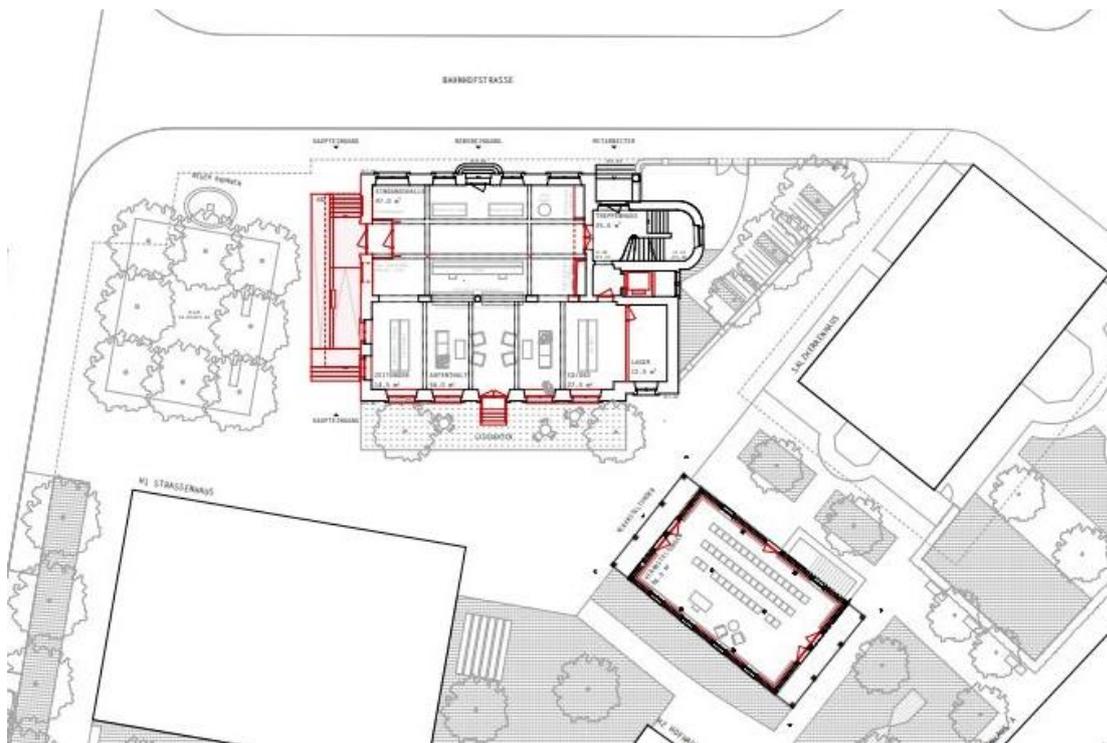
Grundriss der geplanten Kantonsbibliothek mit westseitigem Haupteingang und Lesegarten im Süden.
